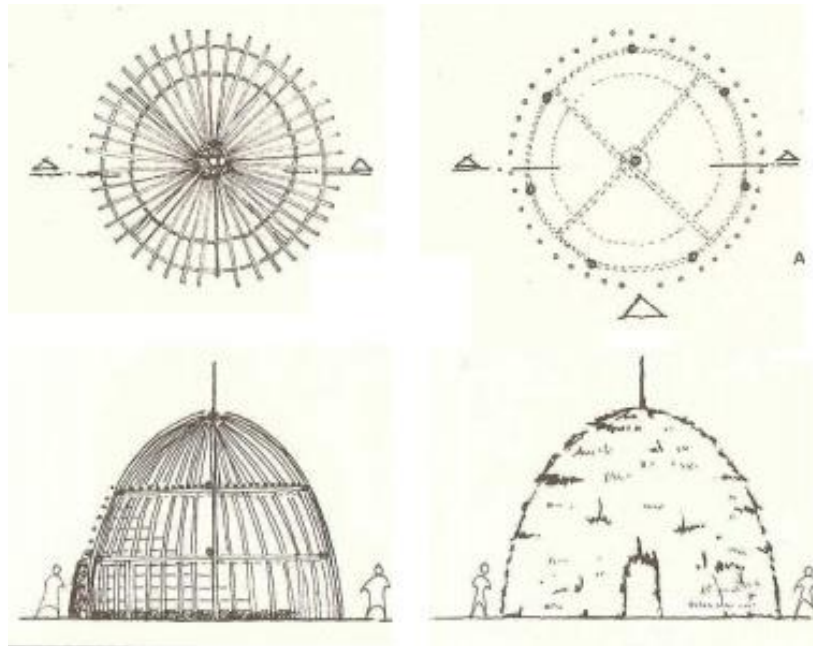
Implantação, planta, corte e fachada da casa Xavante⁴
